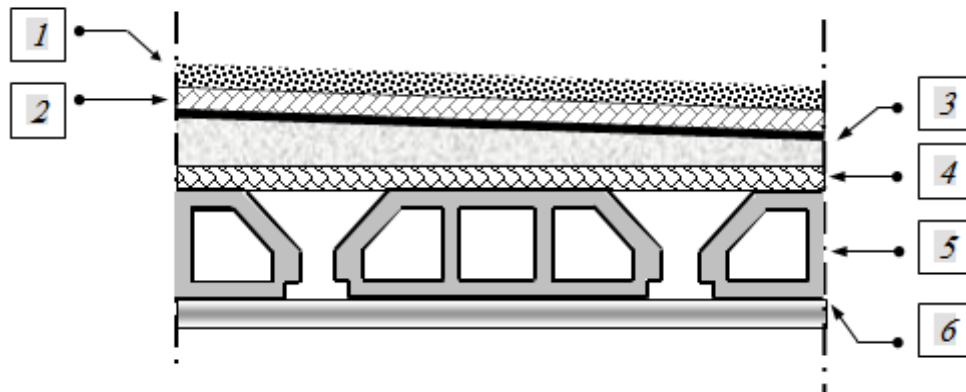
Coupe verticale du plancher terrasse à corps creux.
